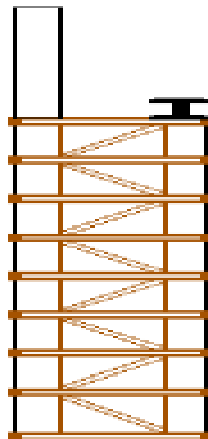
POTEAU COMPOSE SUPPORTANT UNE POUTRE DE ROULEMENT DE PONT ROULANT[3]
